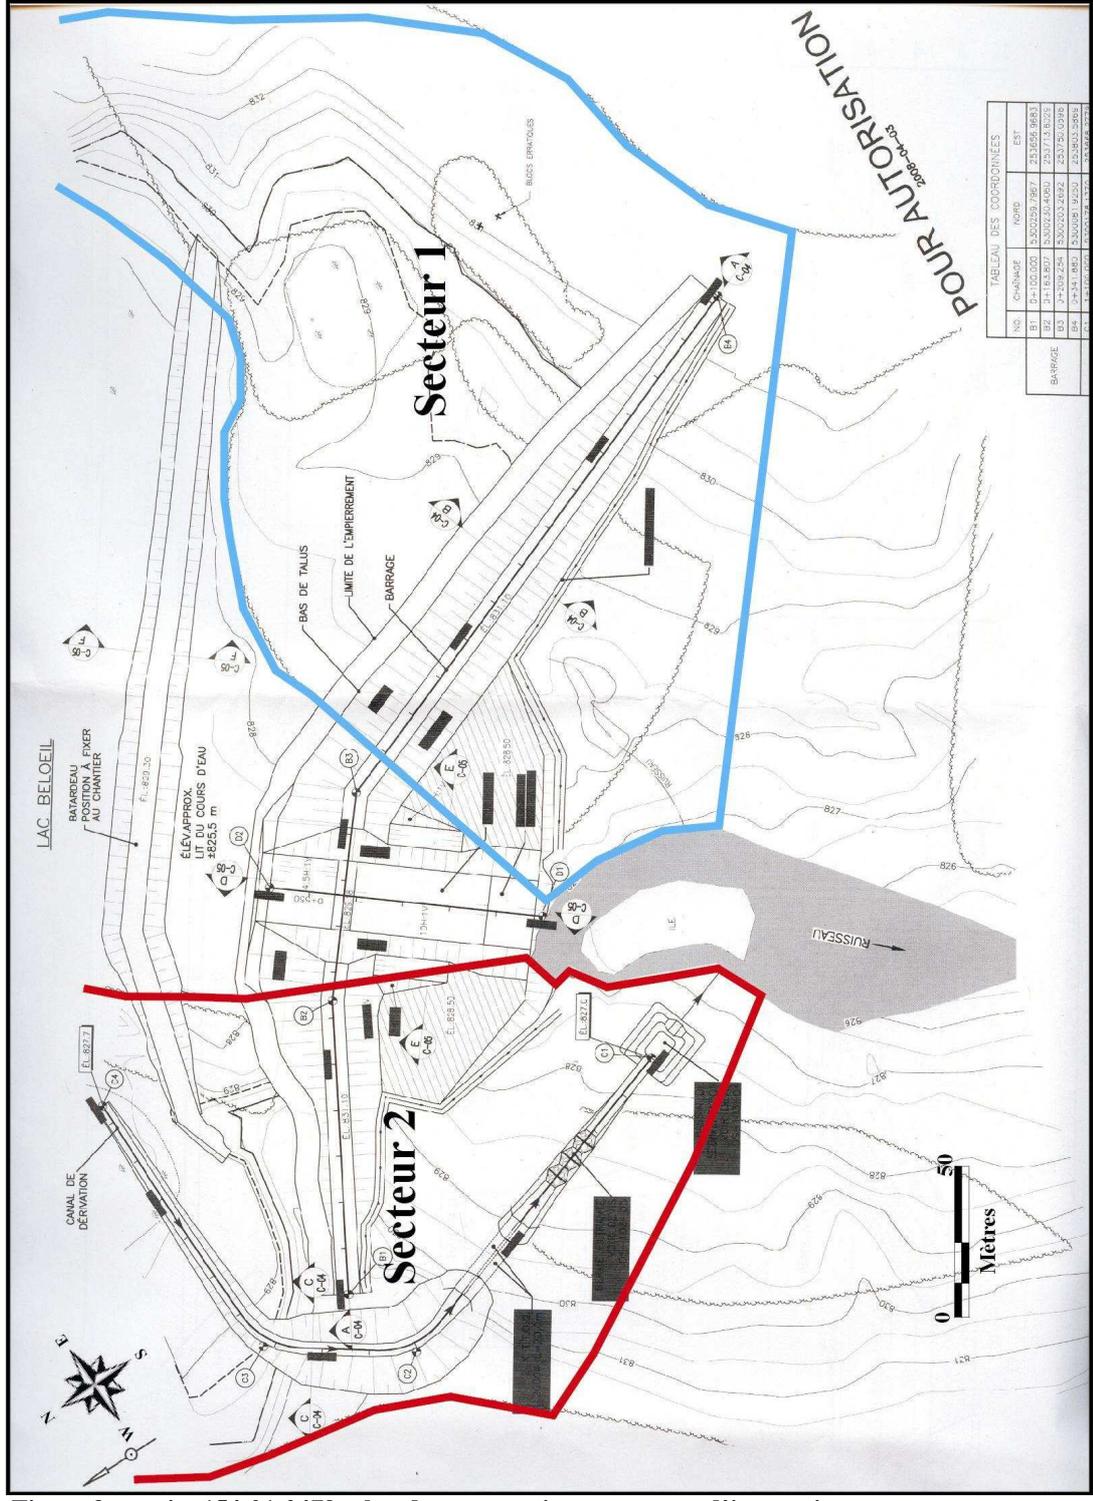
projet 154-01-0479, plan de construction et secteurs d'inventaire.
